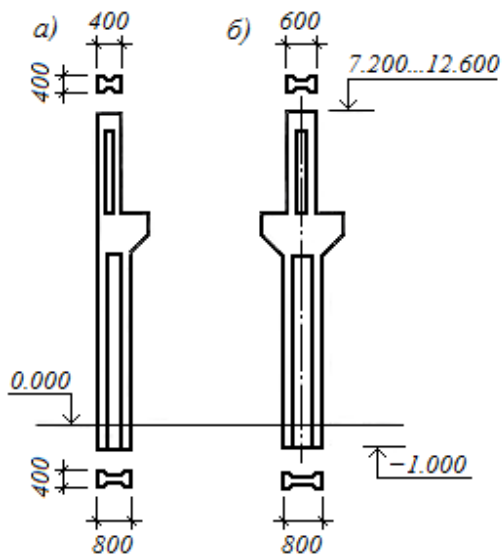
Збірні колони двотаврового перерізу для будівель з мостовими кранами: *a* – крайніх рядів; *б* – середніх рядів
